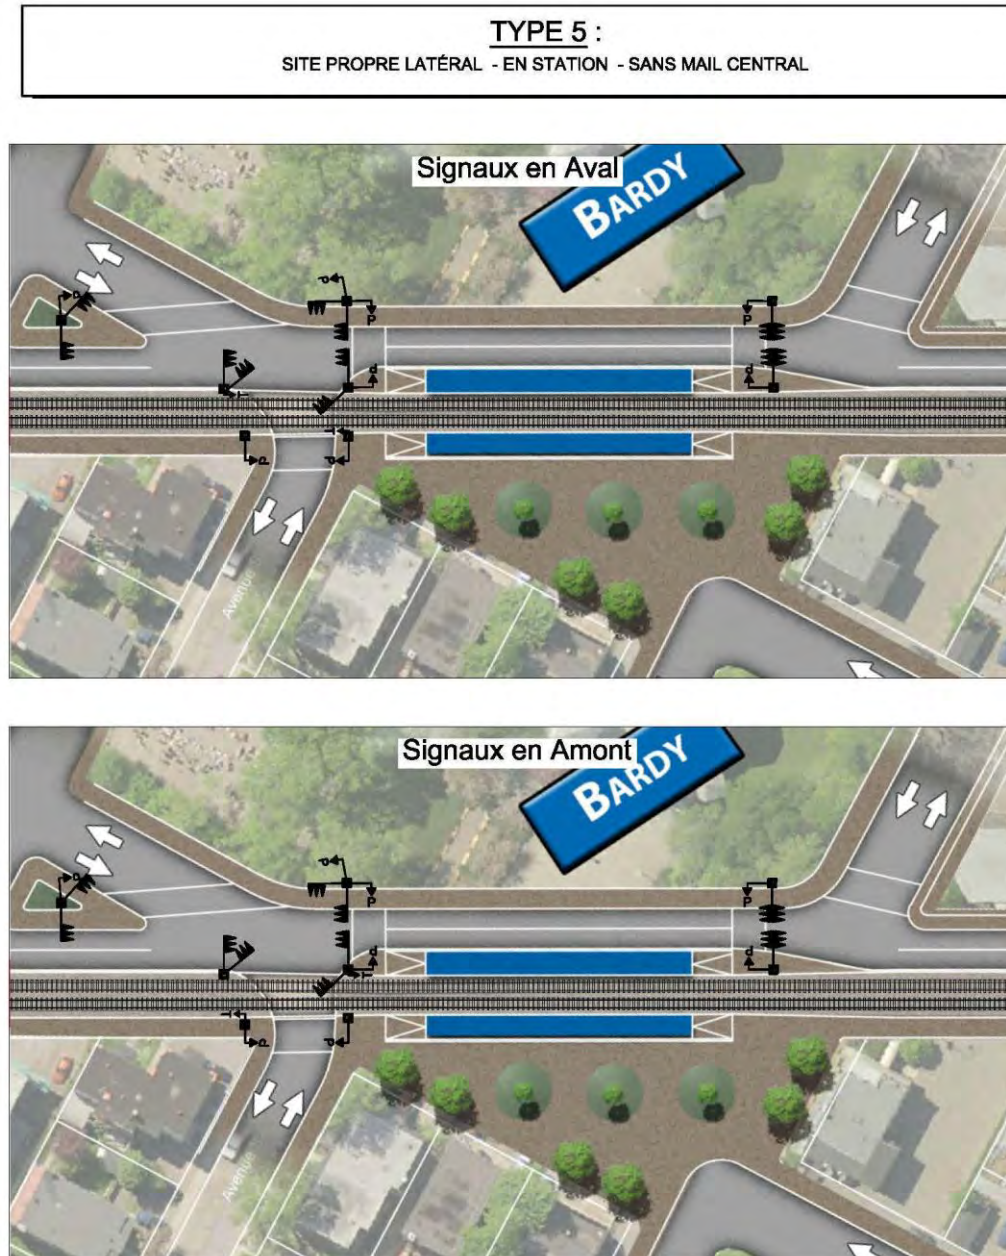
Disposition des signaux lumineux aux carrefours pour le tramway en site propre en position latérale – en station – sans mail central
